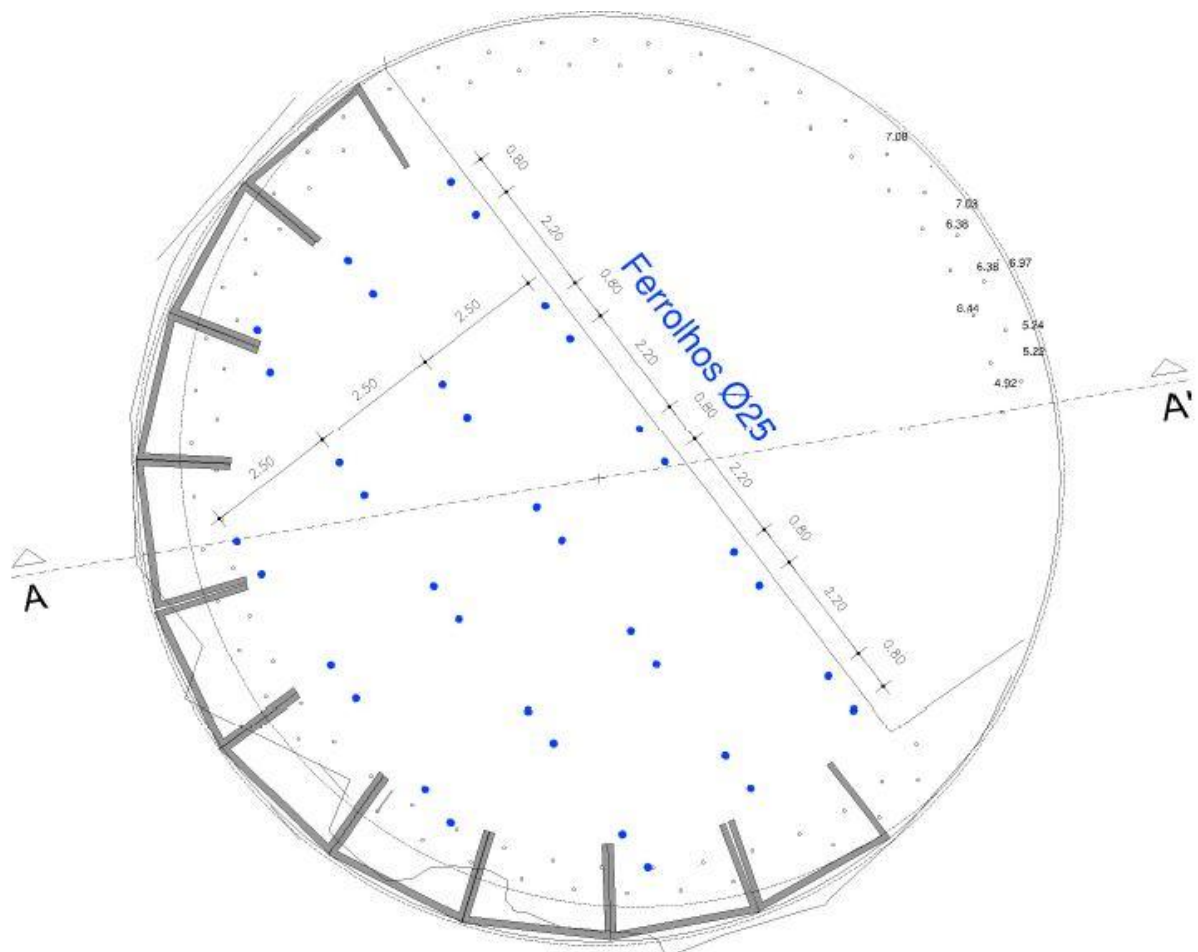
Figura H – Planta da 1ª fase de betonagem (APDL, 2015).
